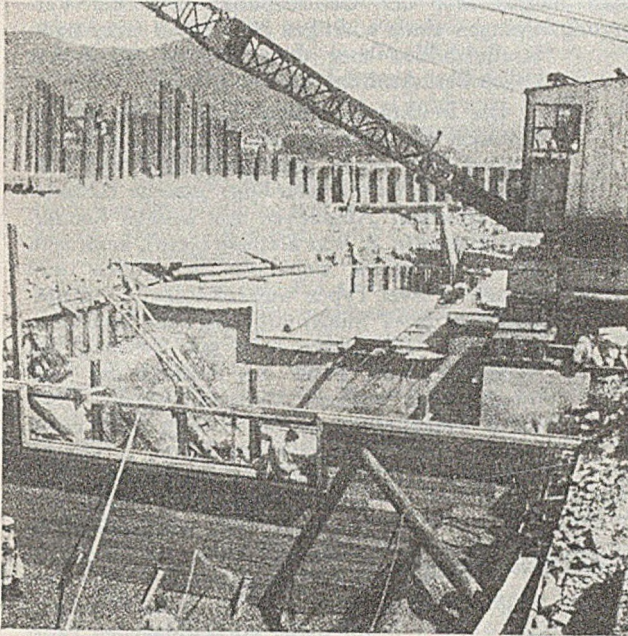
Baugrube des rechten Strompfeilers. Abschnittsweiser Bau des Betontröges.
